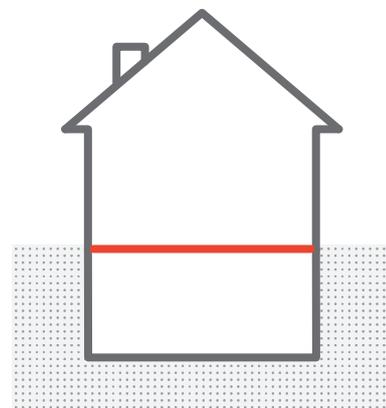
Colocación de la barrera en el cerramiento entre el sótano y la planta baja
